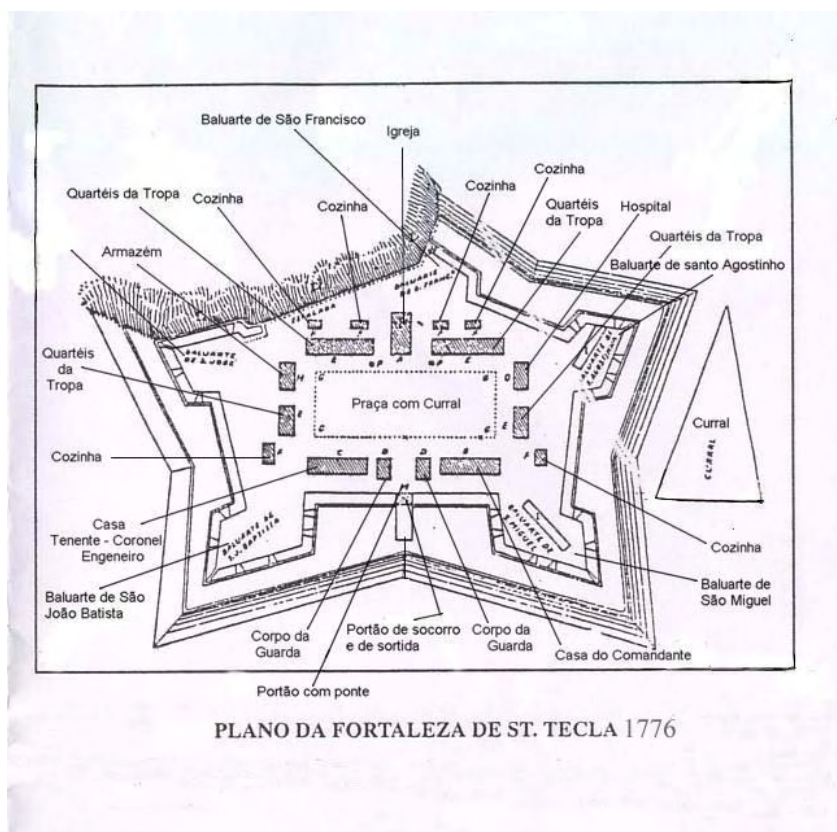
Planta 2a - Distribuição espacial dos estabelecimentos Internos da fortificação segundo a Planta n° 2
